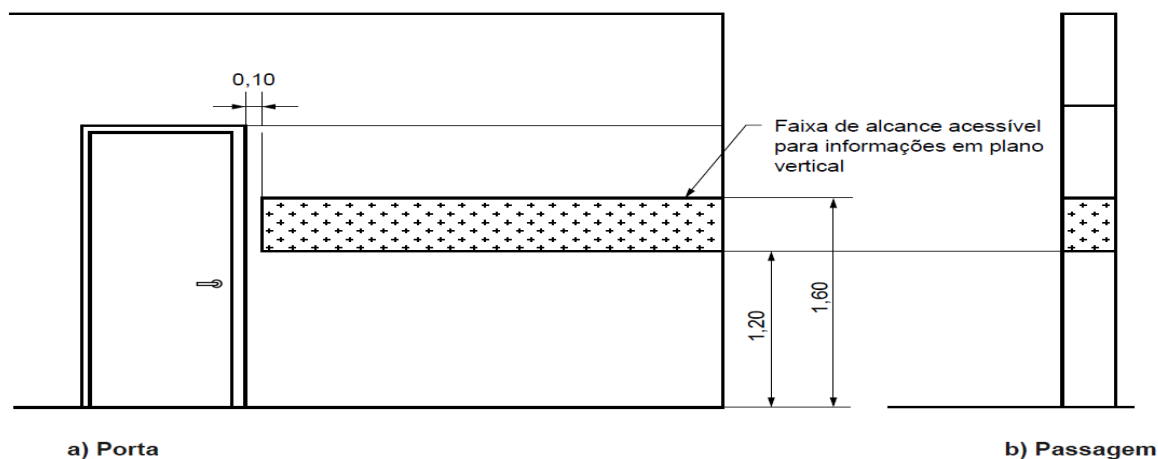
Sinalização de portas e passagens – Faixa de alcance acessível
